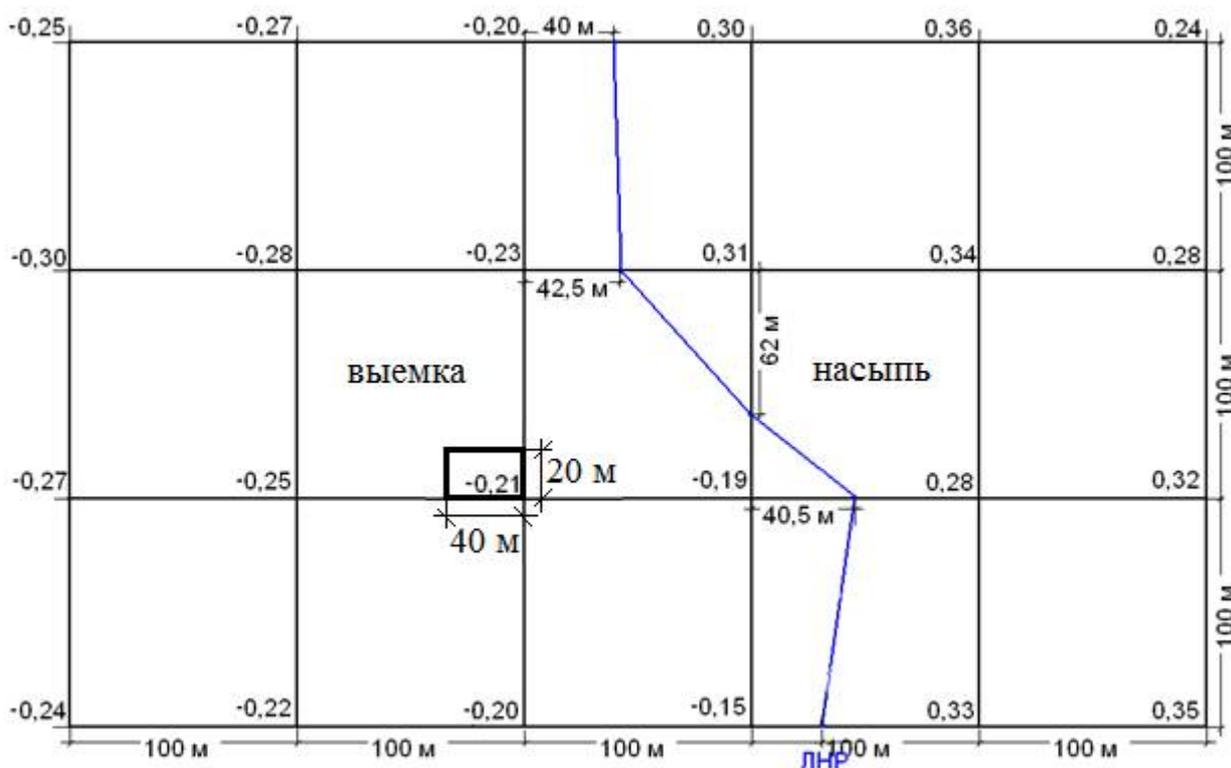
План строительной площадки с рабочими отметками и линией нулевых работ, разделяющей зону выемки и зону насыпи.
